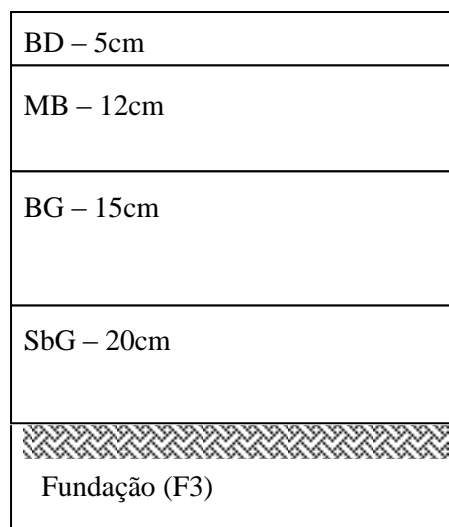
Estrutura obtida do dimensionamento com incorporação de solo-cimento em leito de pavimento.
